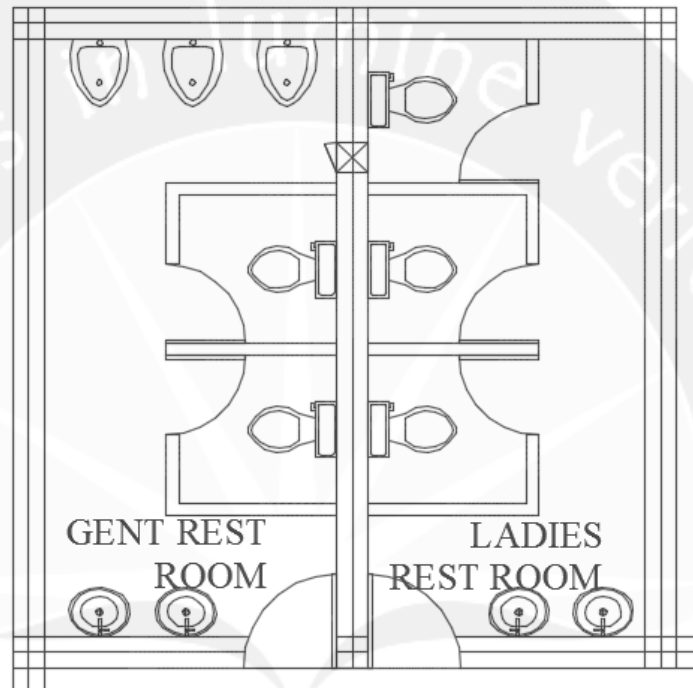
Kebutuhan Ruang Museum lantai 3
